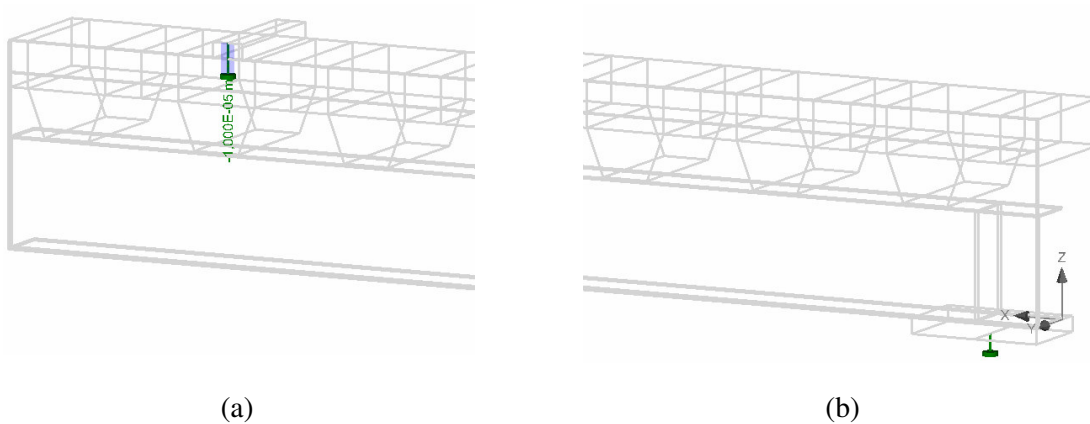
Viga mista de laje nervurada: (a) Condição de carregamento; (b) Condição de apoio.
